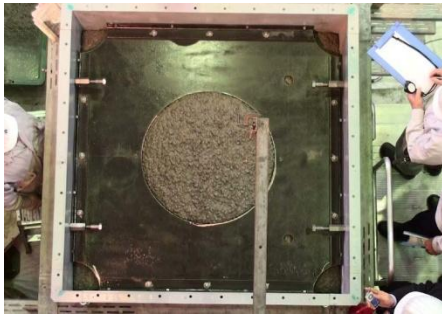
鋼管内上昇中のコンクリート (圧入試験)
